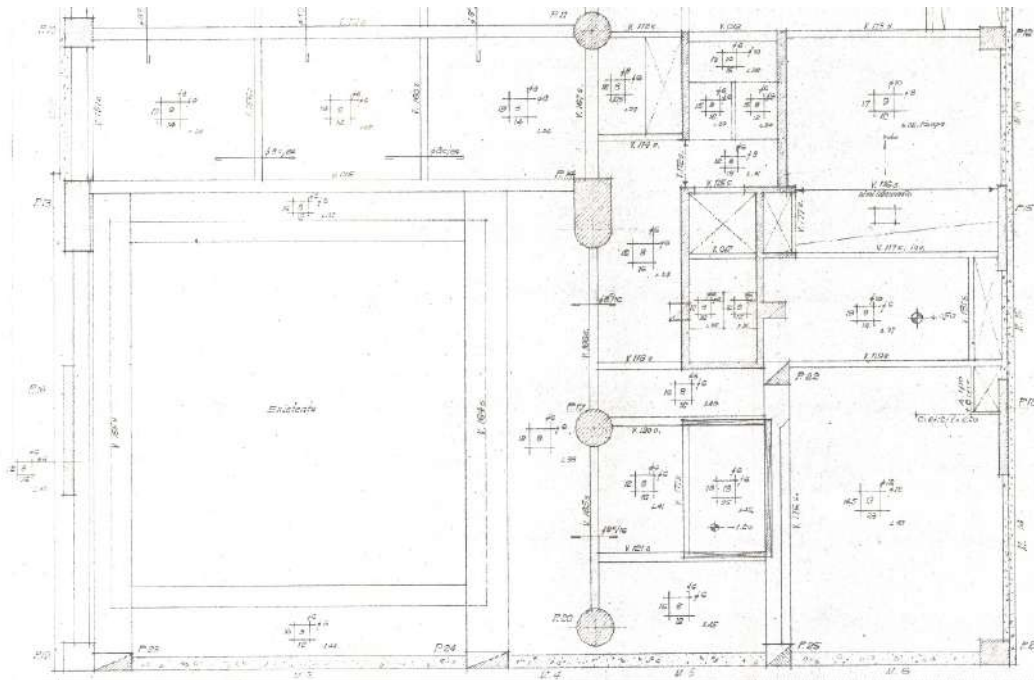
Detalle de la planta de estructuras del primer subsuelo del BCLA donde se ve aislada la bóveda. Indicada como *Existente*.
